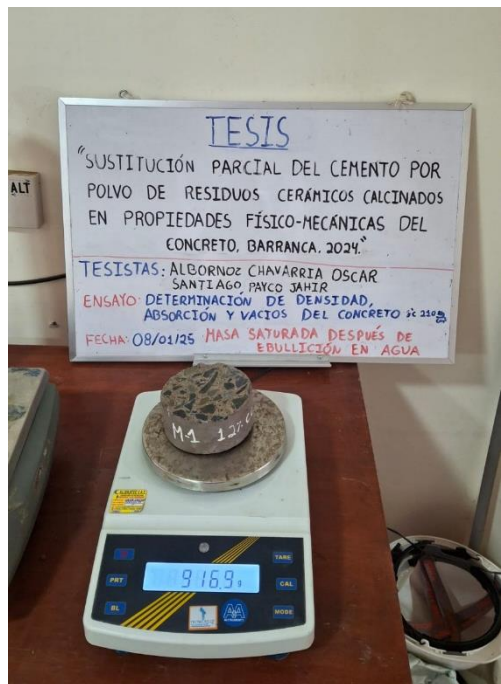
Muestras de concreto endurecido saturadas después de inmersión.
